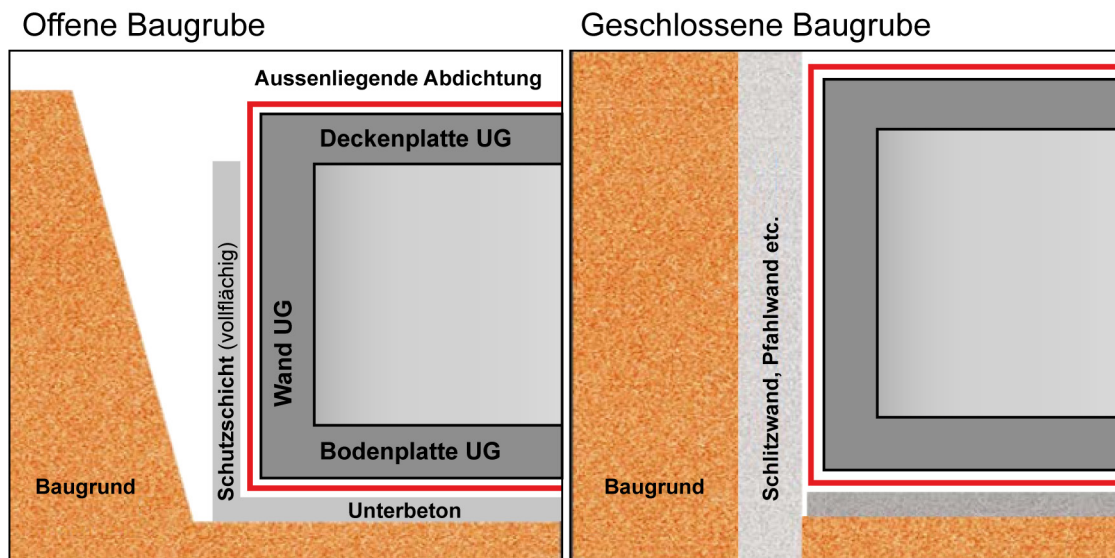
Konstruktion mit aussenliegender Kunststoffdichtung für eine offene Baugrube (links) und eine geschlossene Baugrube (rechts)
